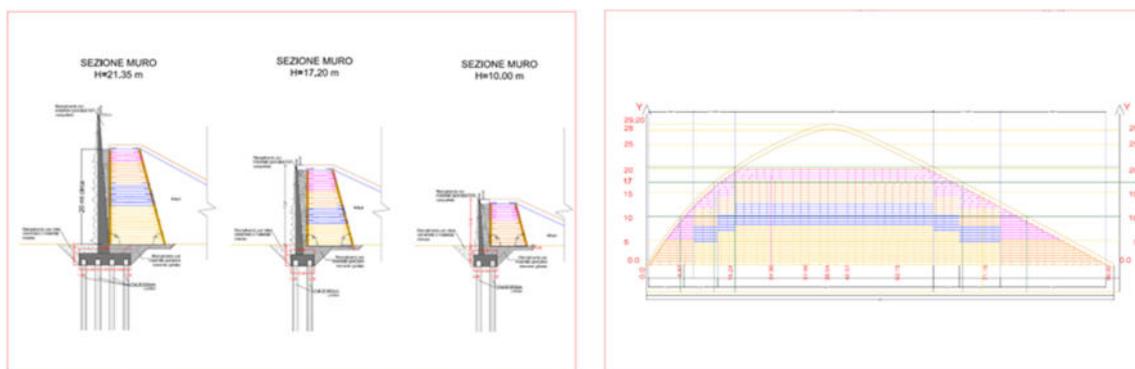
Sezioni trasversali e profilo longitudinale della terra rinforzata dietro la parete di arrampicata.
